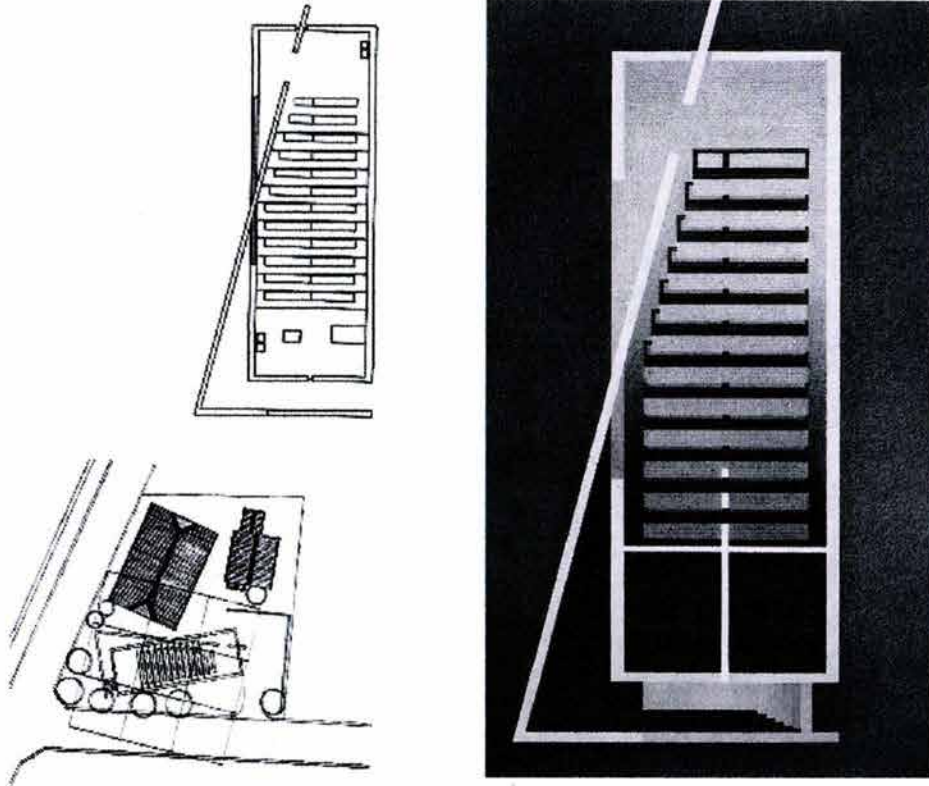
y 39 Planta arquitectónica y de conjunto de la Capilla de la Luz, además de una lámina de la planta; tomadas del libro: Op. Cit. 32 p. 121
